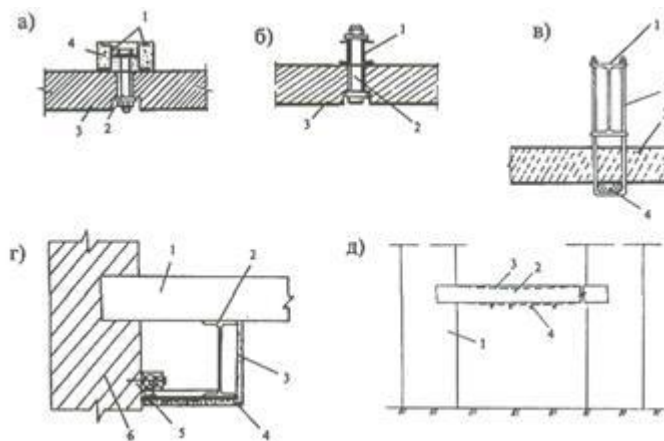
Схемы устранения прогибов перекрытий полносборных зданий
